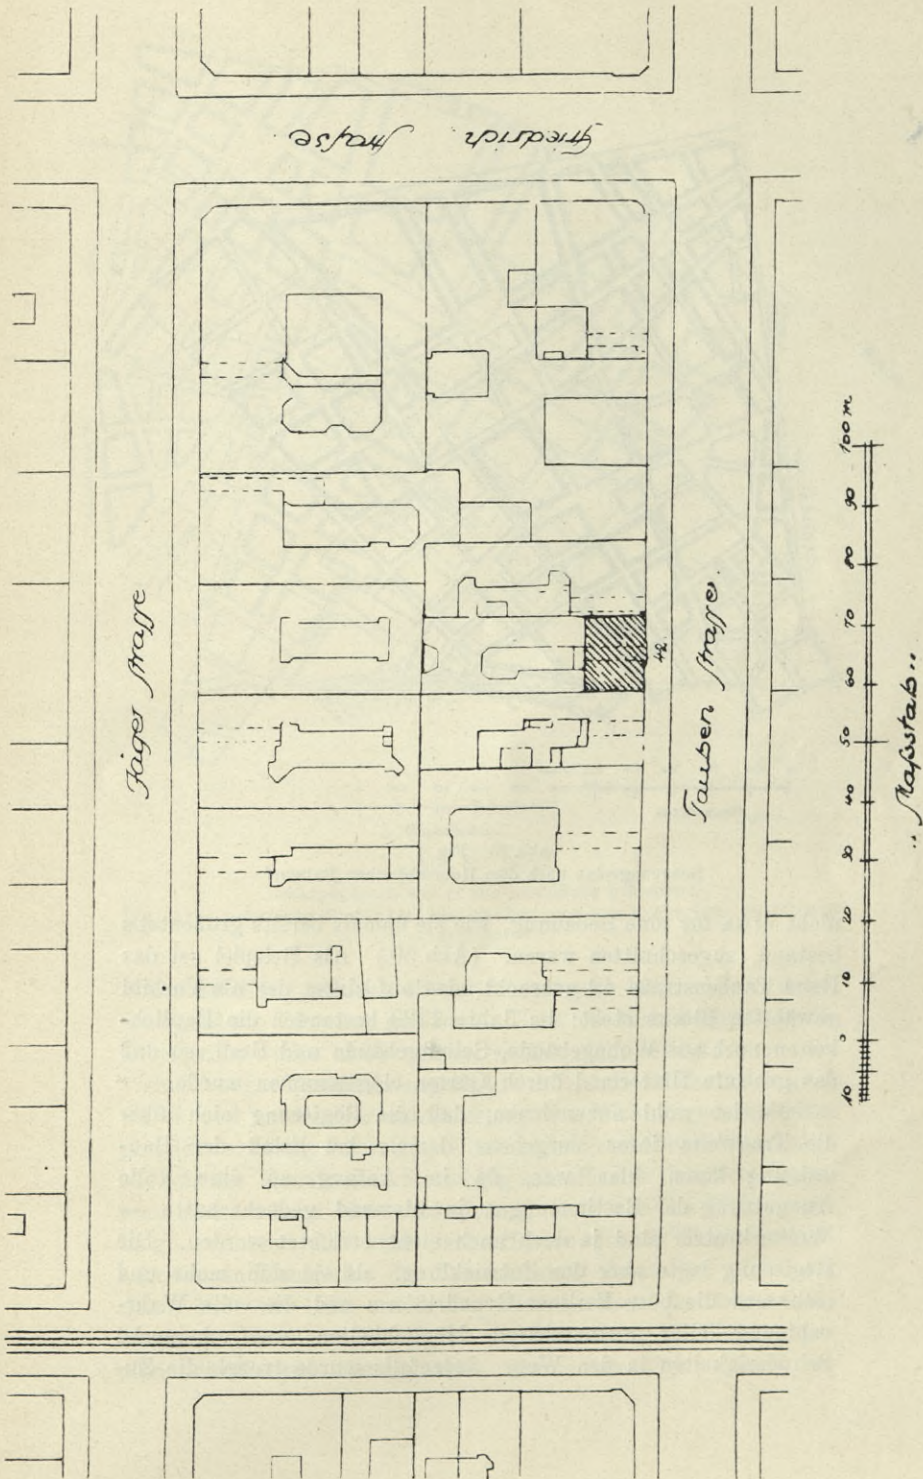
Baublock in der Friedrichstadt mit Eintragung eines Hauses in der ursprünglichen Bebauungsart
